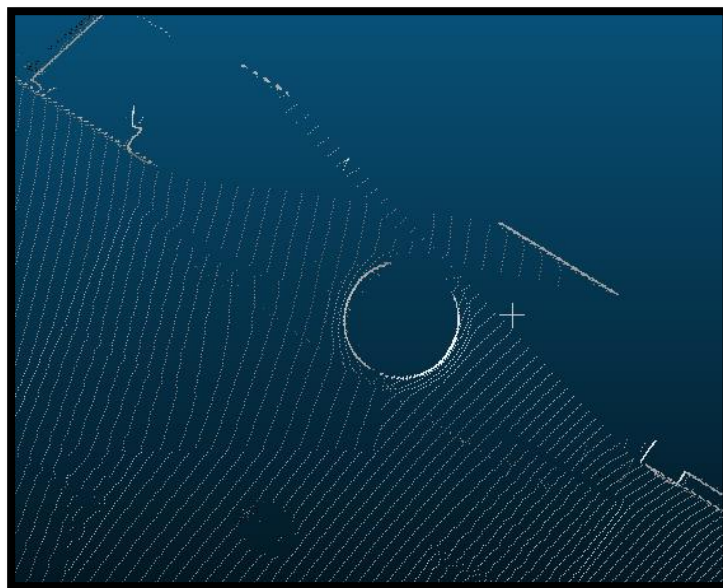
Detalle del análisis de una de las columnas de la planta baja.
